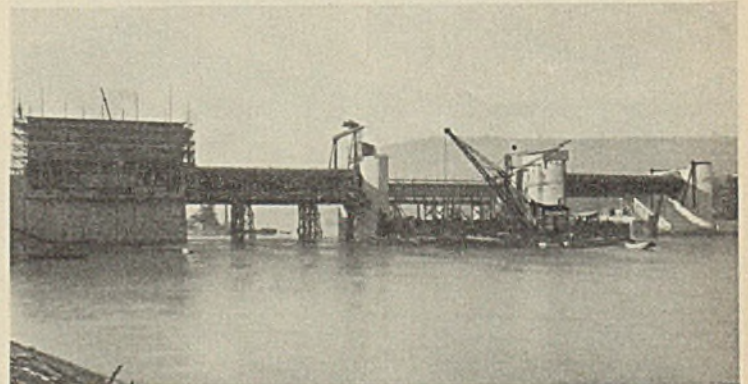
Staustufe Gundelsheim. Kraftwerk und Wehr mit Fahrbrücke im Bau.
